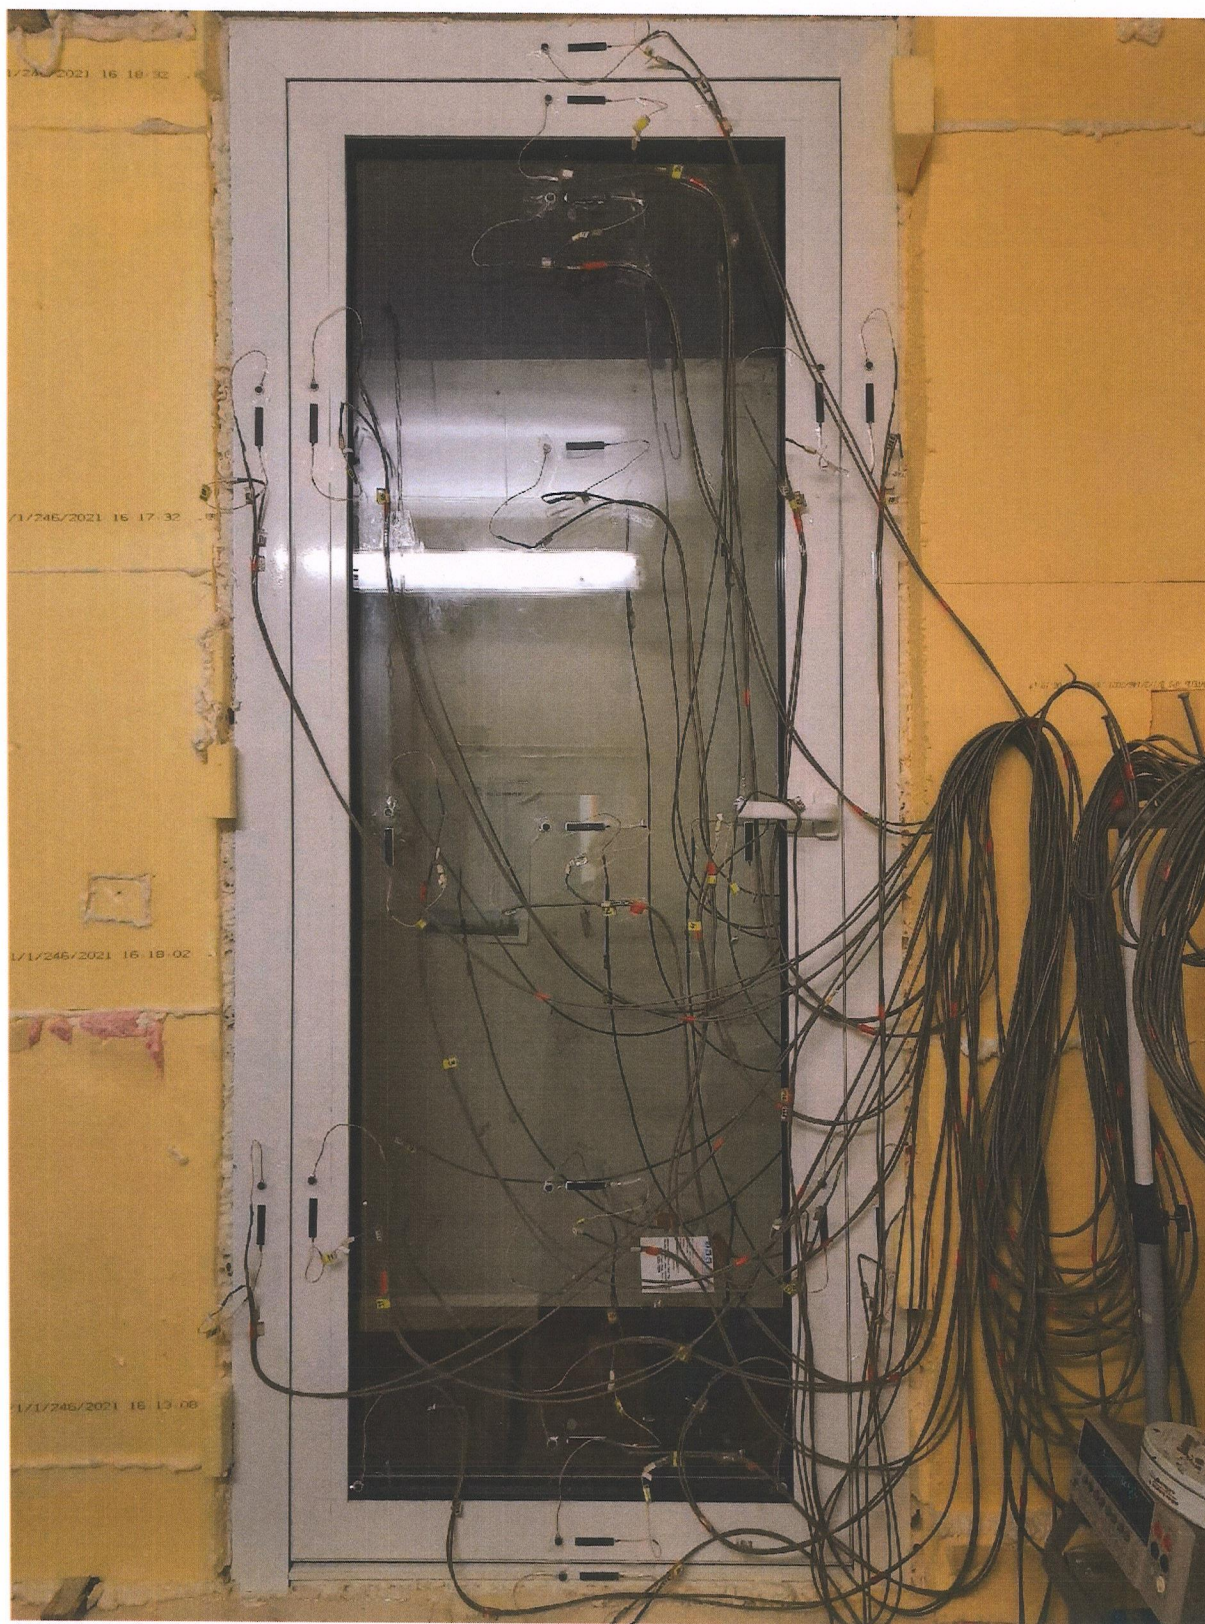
Внешний вид блока дверного, установленного в климатической камере.
